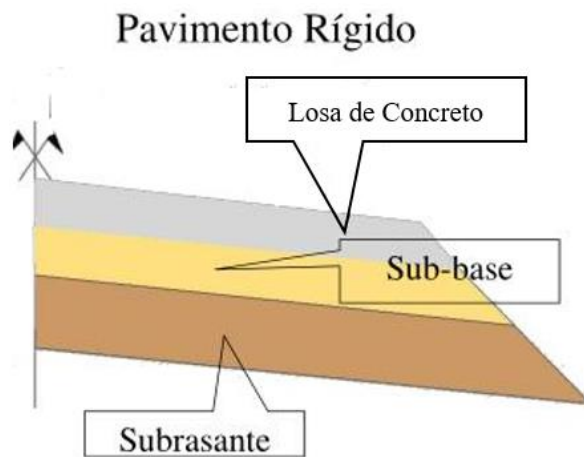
Capas de un Pavimento Rígido (Recuperado de:
